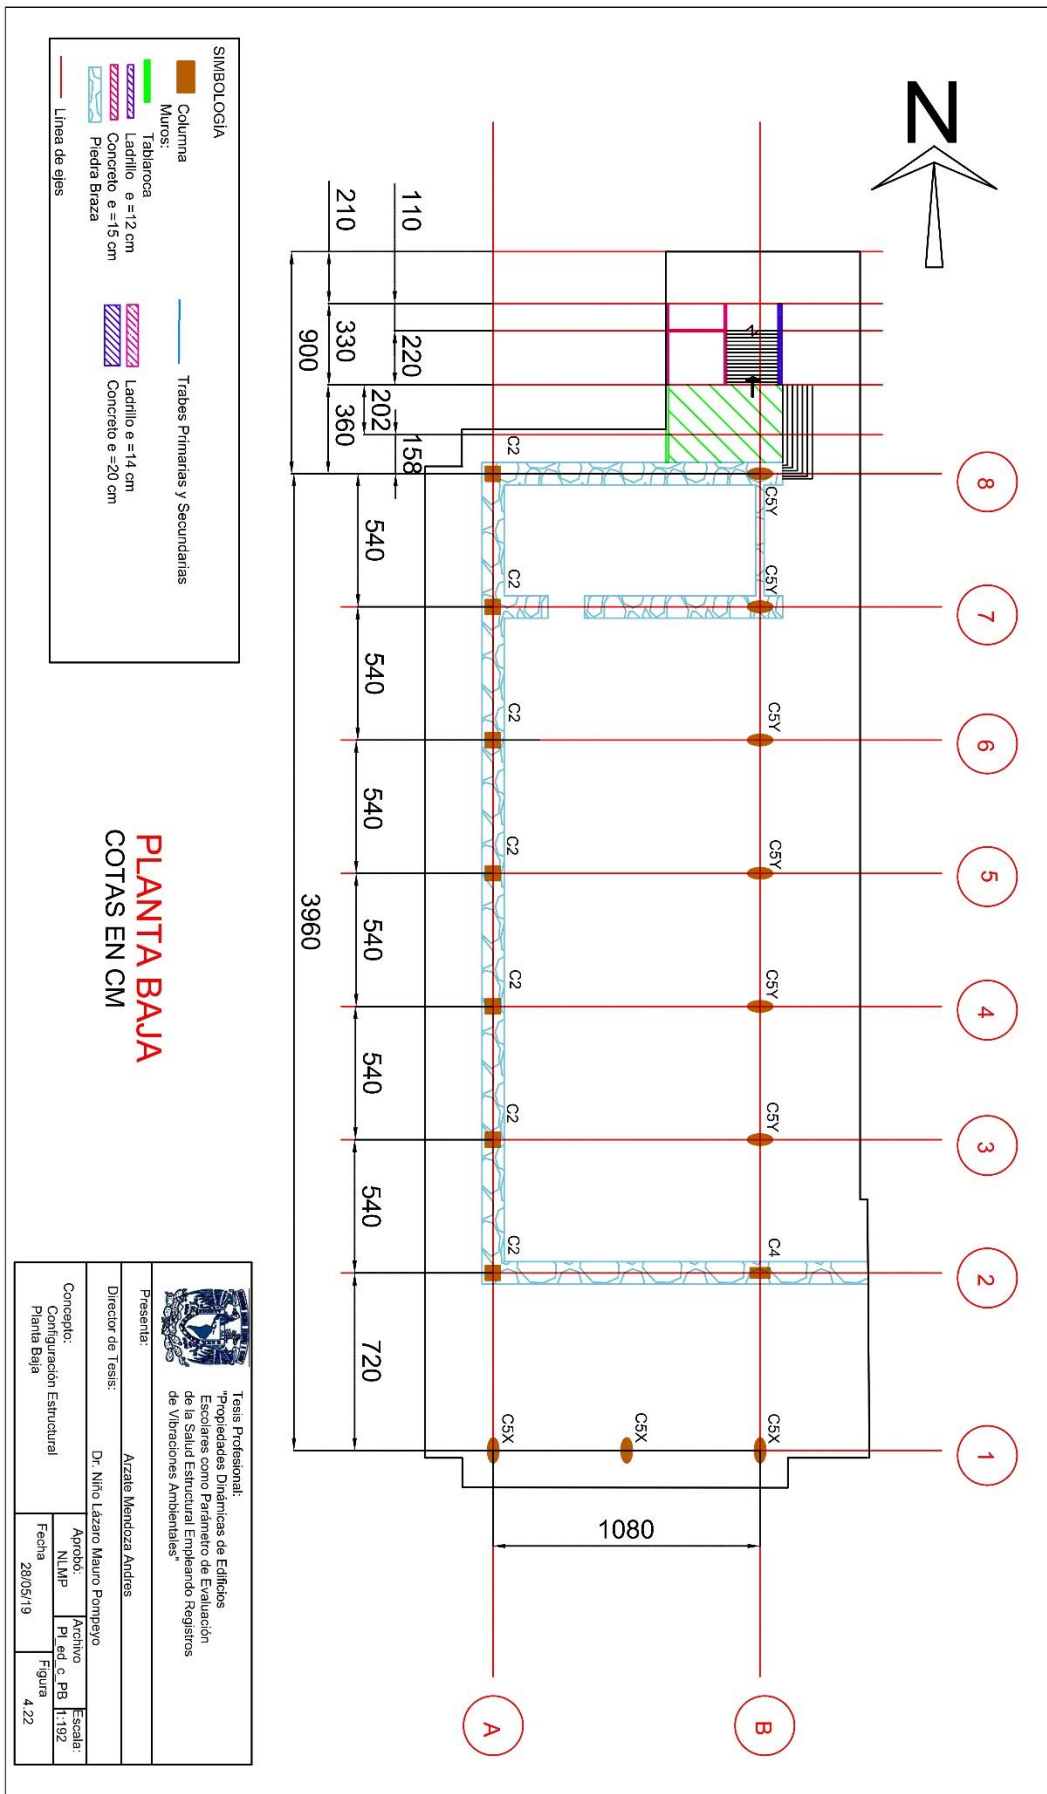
Planta estructural planta baja edificio C FI, UNAM
